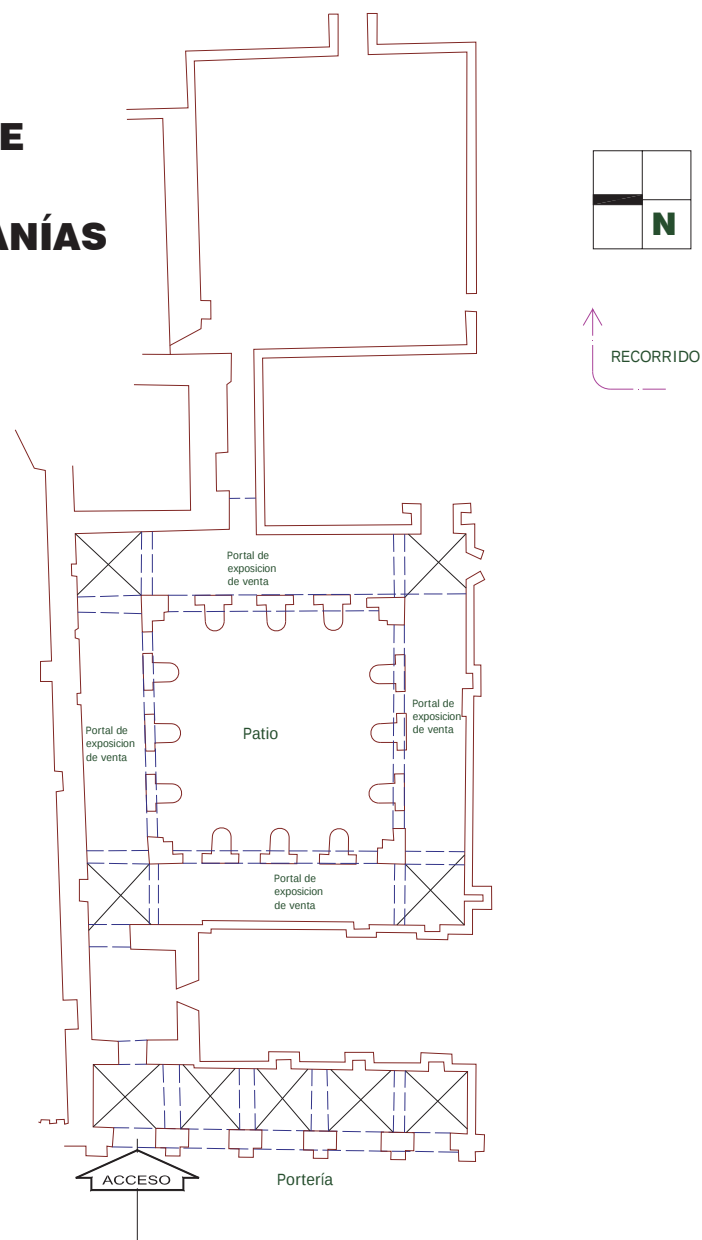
Planta general, Casa de las Artesanías, exconveto de San Francisco.
